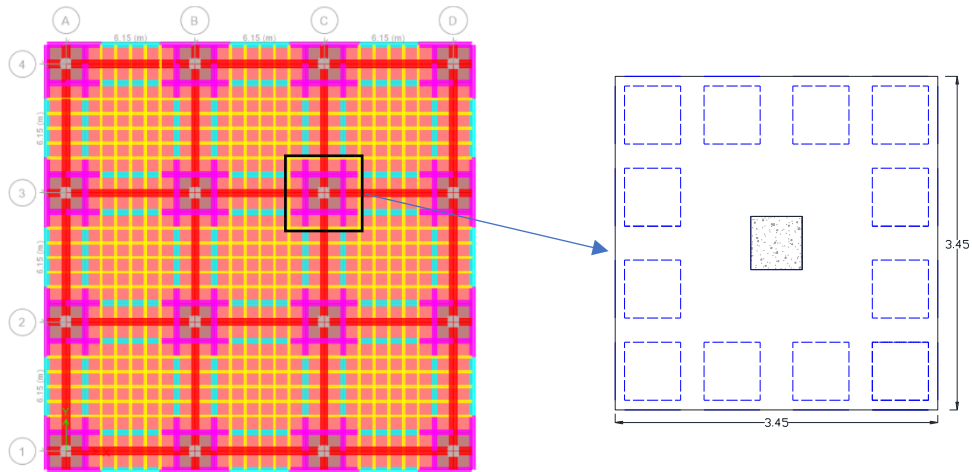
Ubicación del espécimen en estudio en la estructura prototipo, vista en planta.
